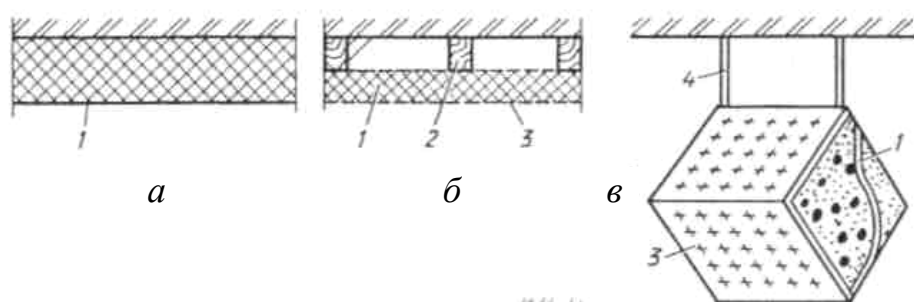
Звукопоглинаючі конструкції: 1 — звукопоглинаючий пористий матеріал; 2 — дерев'яний каркас; 3 — перфорований лист; 4 — підвіска
